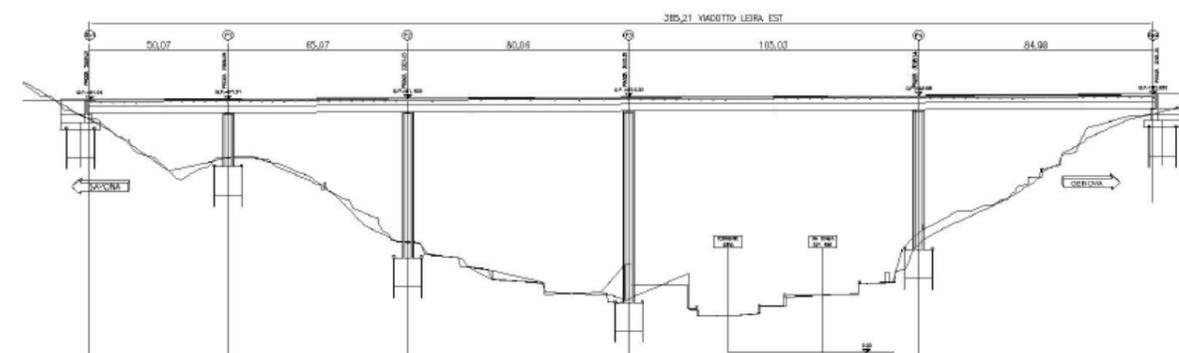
Profilo longitudinale viadotti Leiro Est e Ovest
